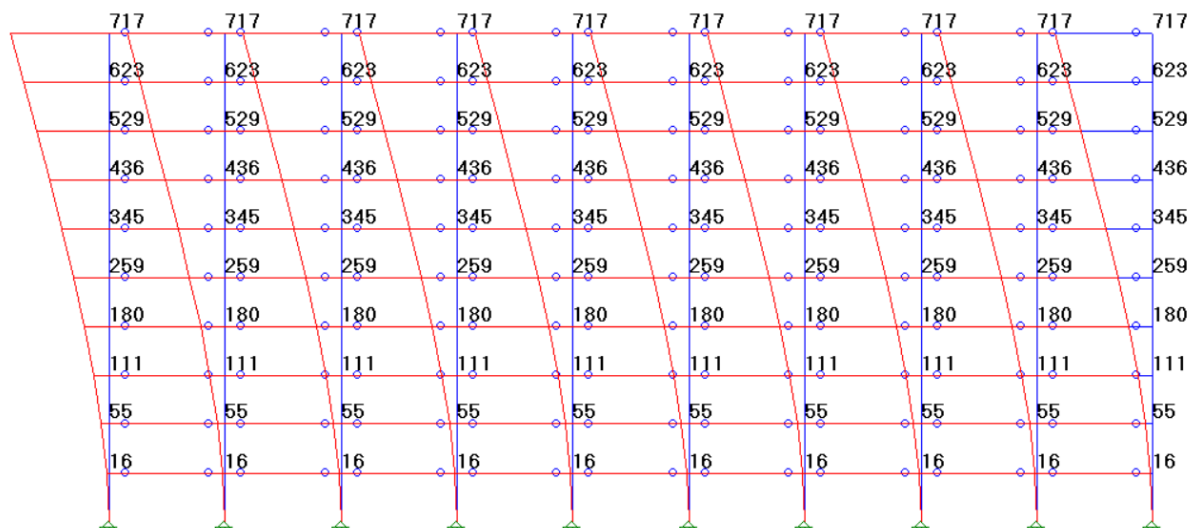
Esquema das ações externas equivalentes em 0° do edifício garagem contraventado por pilares-parede.
